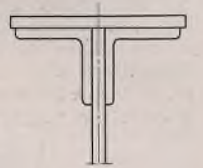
Genieteter Blechträger mit gehobelter Stegblechoberkante.
